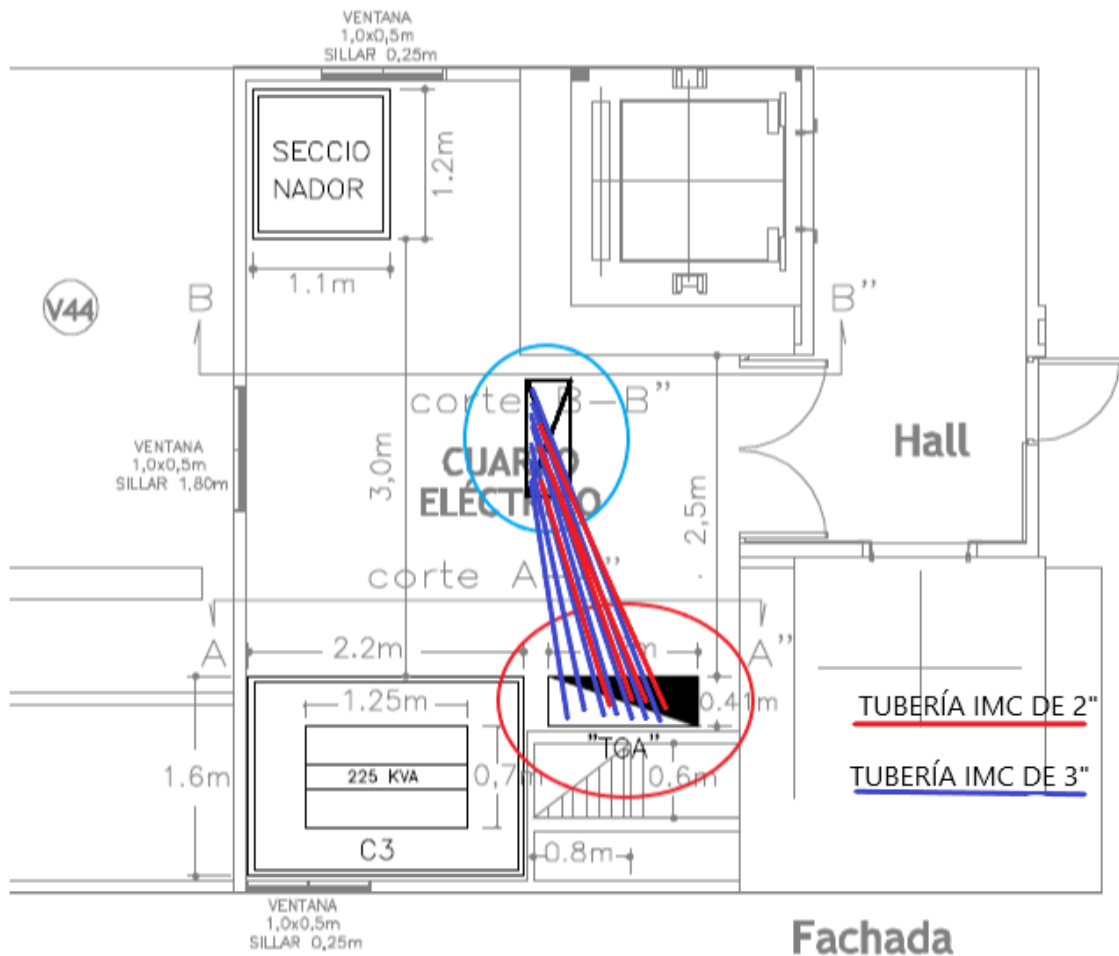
Primer plano entregado por interventoría de la subestación eléctrica de Ventus. Fuente propia.
